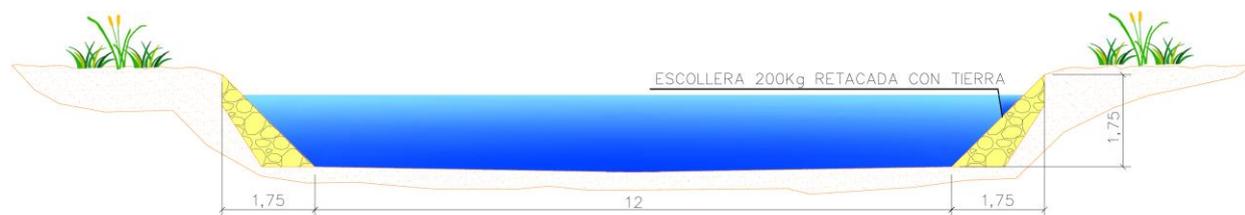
Sección tipo propuesta para el arroyo Los Íberos.
